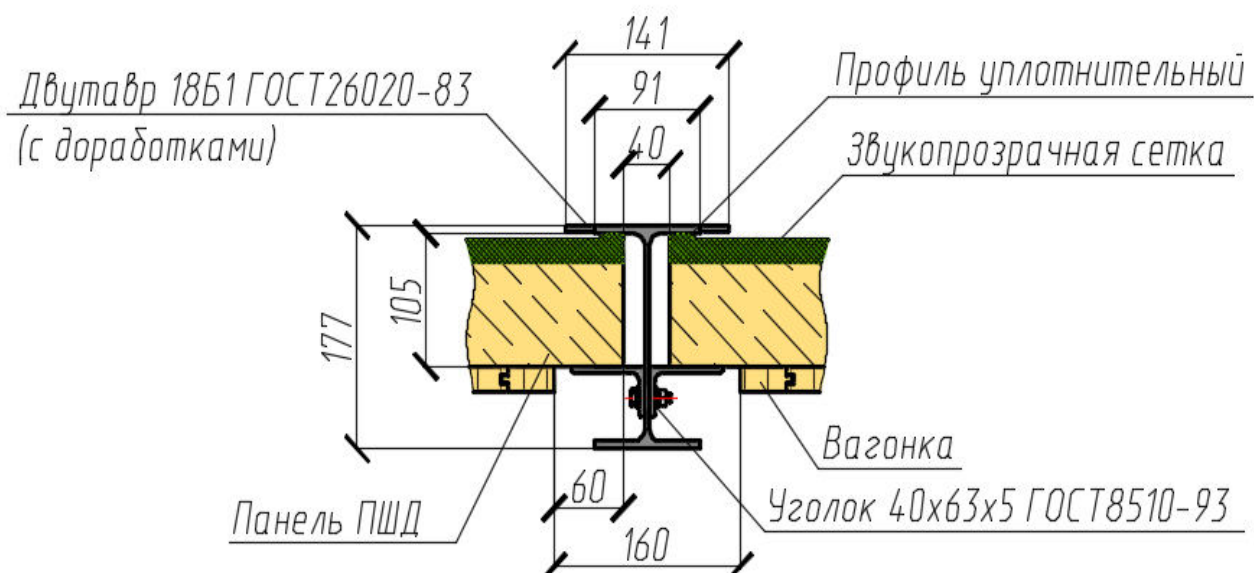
Установка панелей ПШД без перекрытия вагонкой вертикальных несущих элементов
